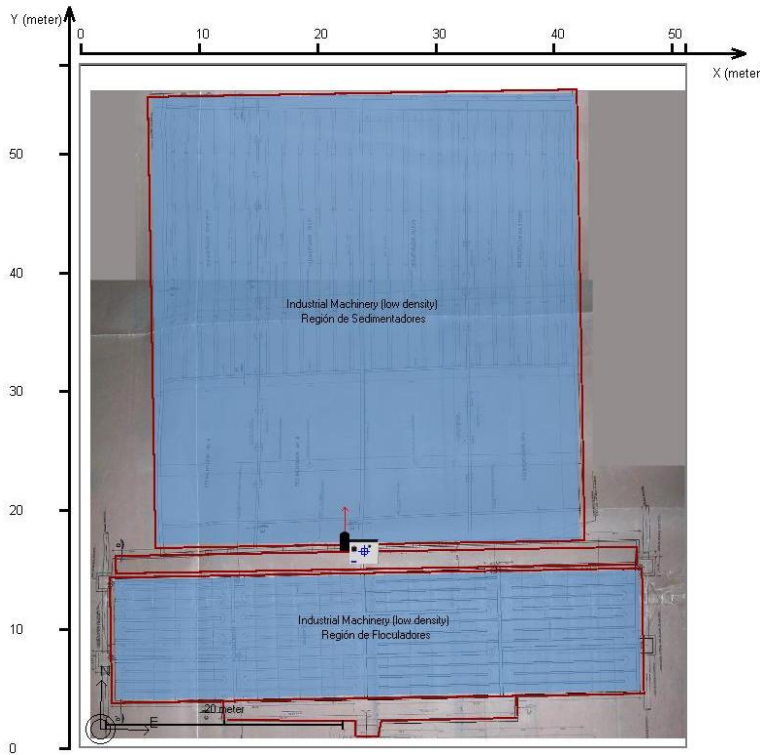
Floor Plan - Flocladores/Sedimentadores planta El Tablazo
